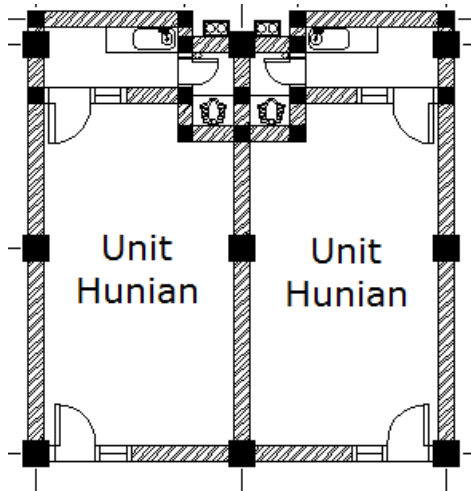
Denah Gedung Rumah Susun Lantai 2 – 5
